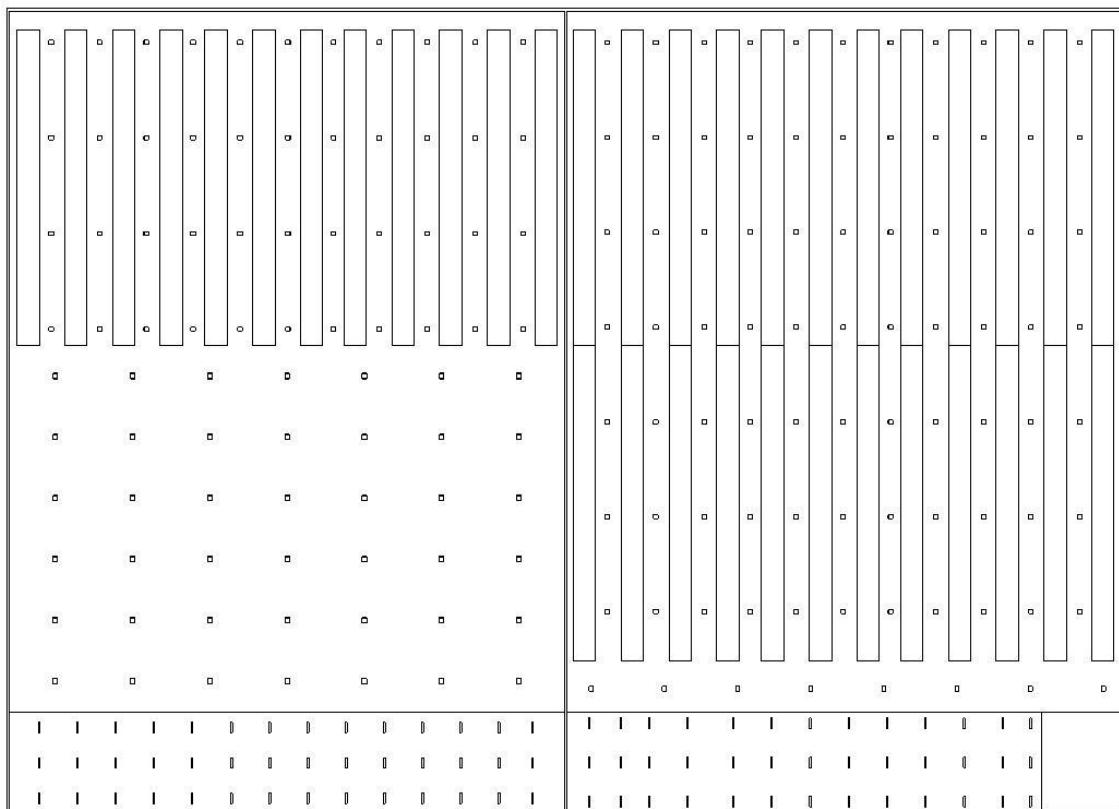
Vista en planta de Naves Tipo 1 y 2.
